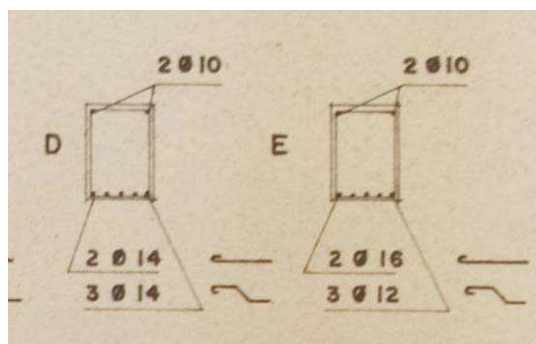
Plano de armado de vigas. Ficha 88c.019, 1966.
